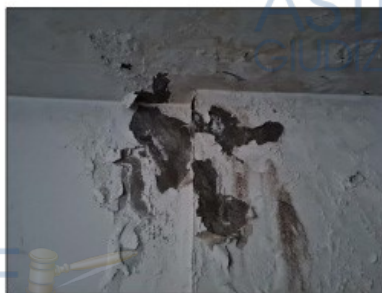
INFILTRAZIONE A PIANO INTERRATO
